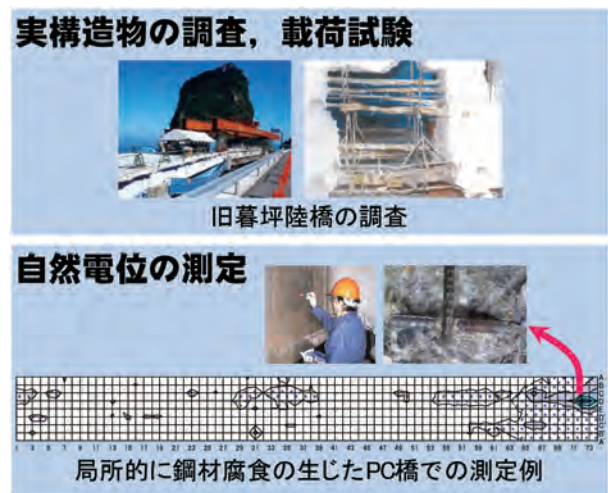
コンクリート構造物の維持管理に関する研究イメージ
